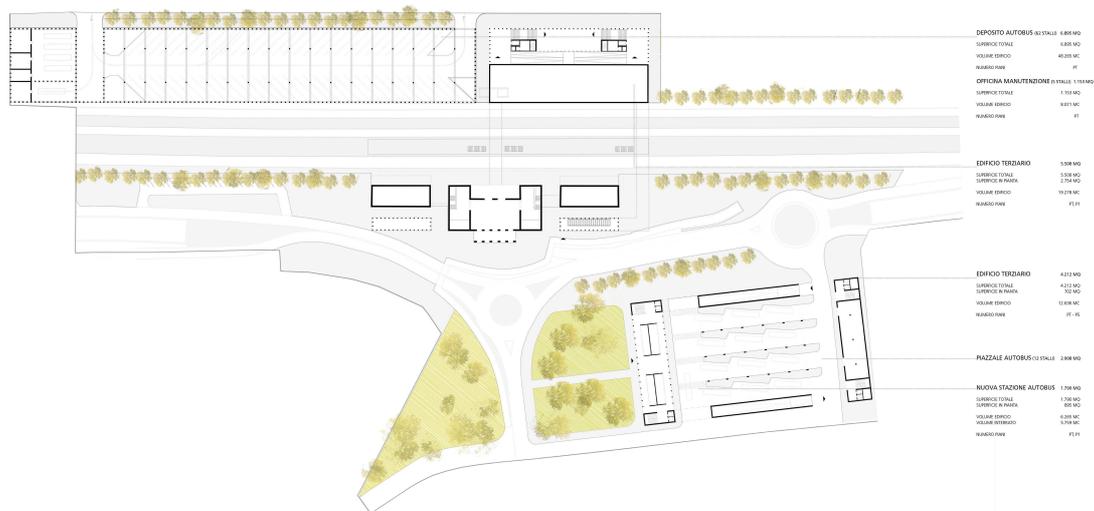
Planimetria del polo intermodale - estratto dal masterplan
